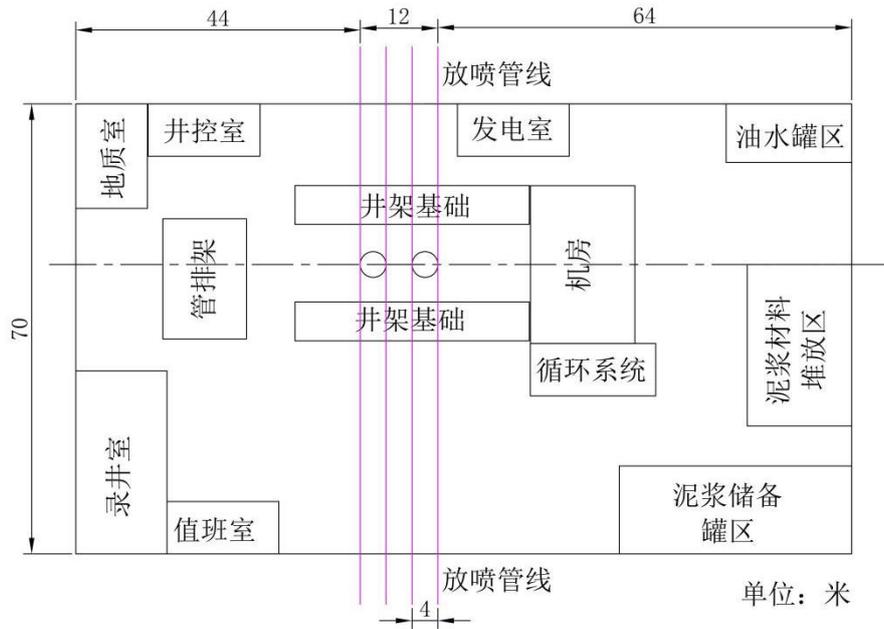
二丛井井场施工平面示意图（单位：m）
